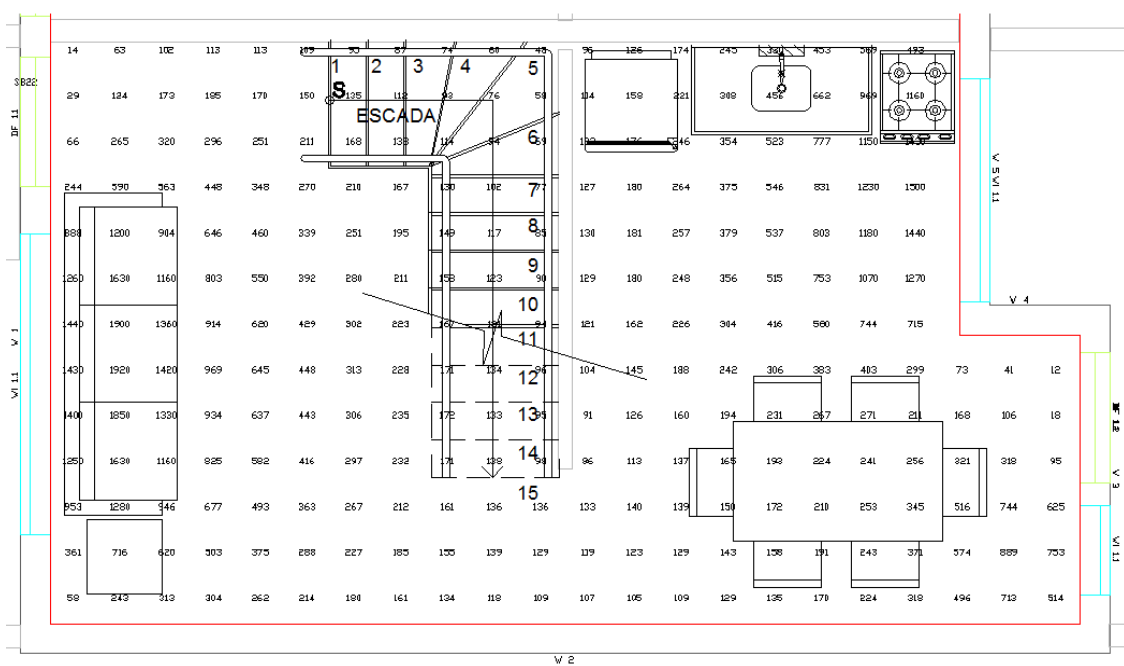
Distribuição da iluminância ponto a ponto no pavimento térreo (em lux).
